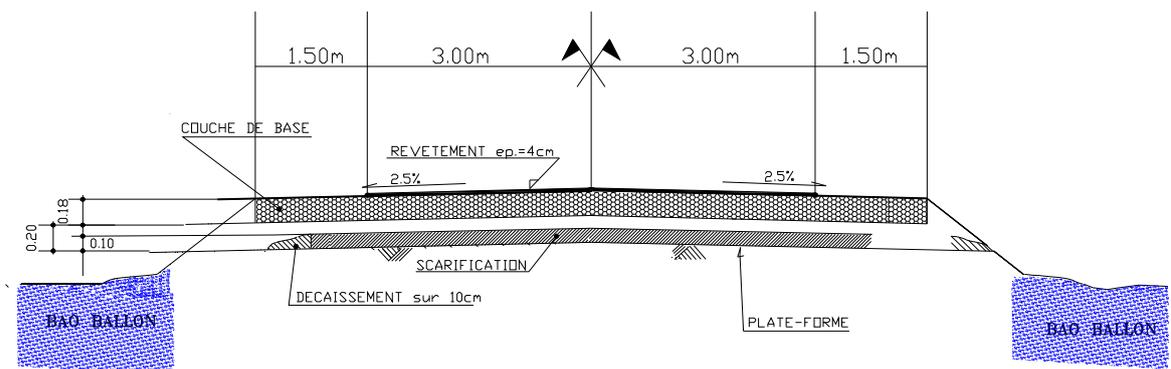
(2) Profil en travers Coupe transversale (Tronçon du Baobolong)
